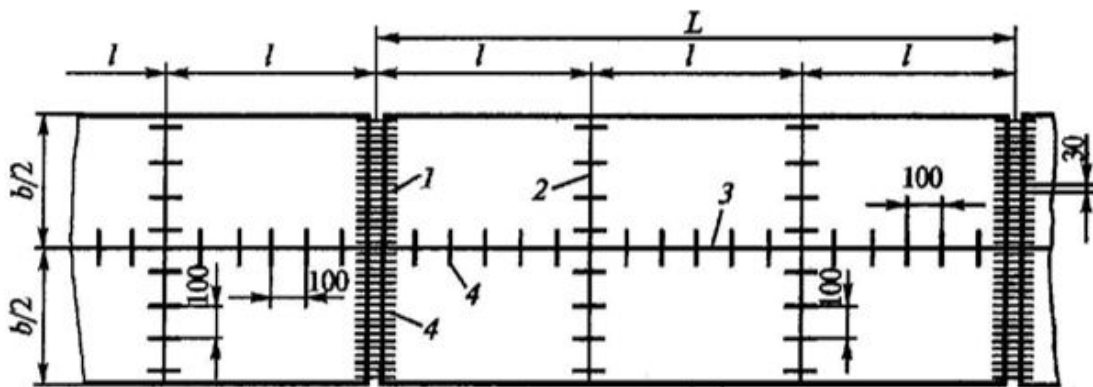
План бетонных плит: 1 – шов расширения; 2 – поперечный шов сжатия; 3 – продольный шов сжатия; 4 – штыри [2]
